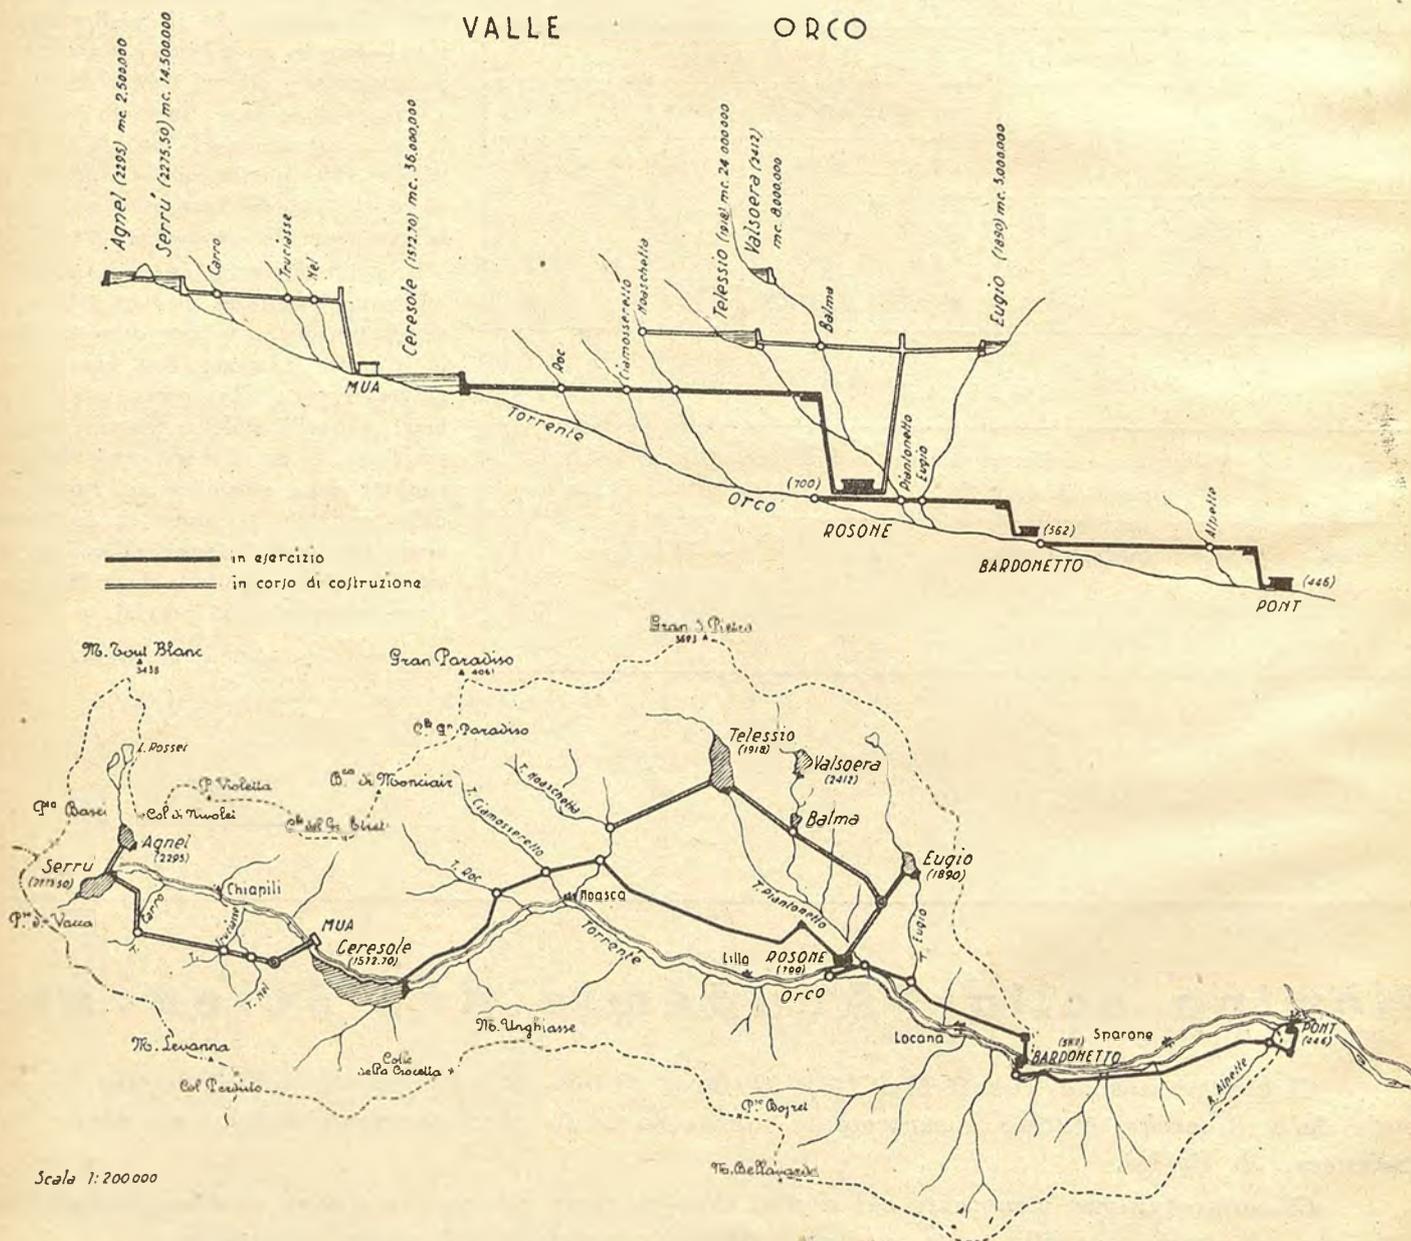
Planimetria e profilo degli impianti in esercizio e in costruzione in Valle Orco
